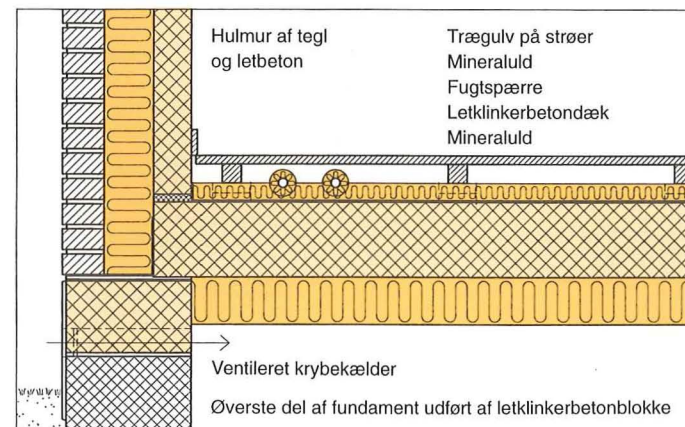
Kuldebroen gennem fundamentets øverste del er brudt ved anvendelse af letklinkerbetonblokke med et isolerende midterlag. Fugtspærre på overside af betonplade beskytter fugtfølsomme dele af gulvkonstruktionen. Fugtspærren kan alternativt placeres direkte under den trykfordelende plade.
